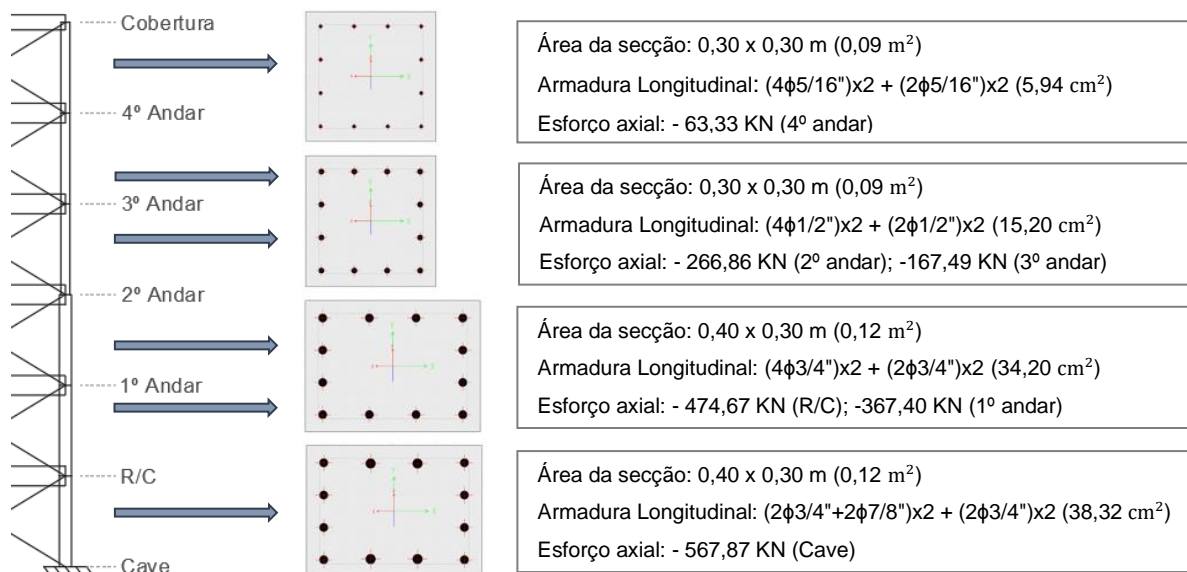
Detalhes das secções dos pilares do eixo 3.
